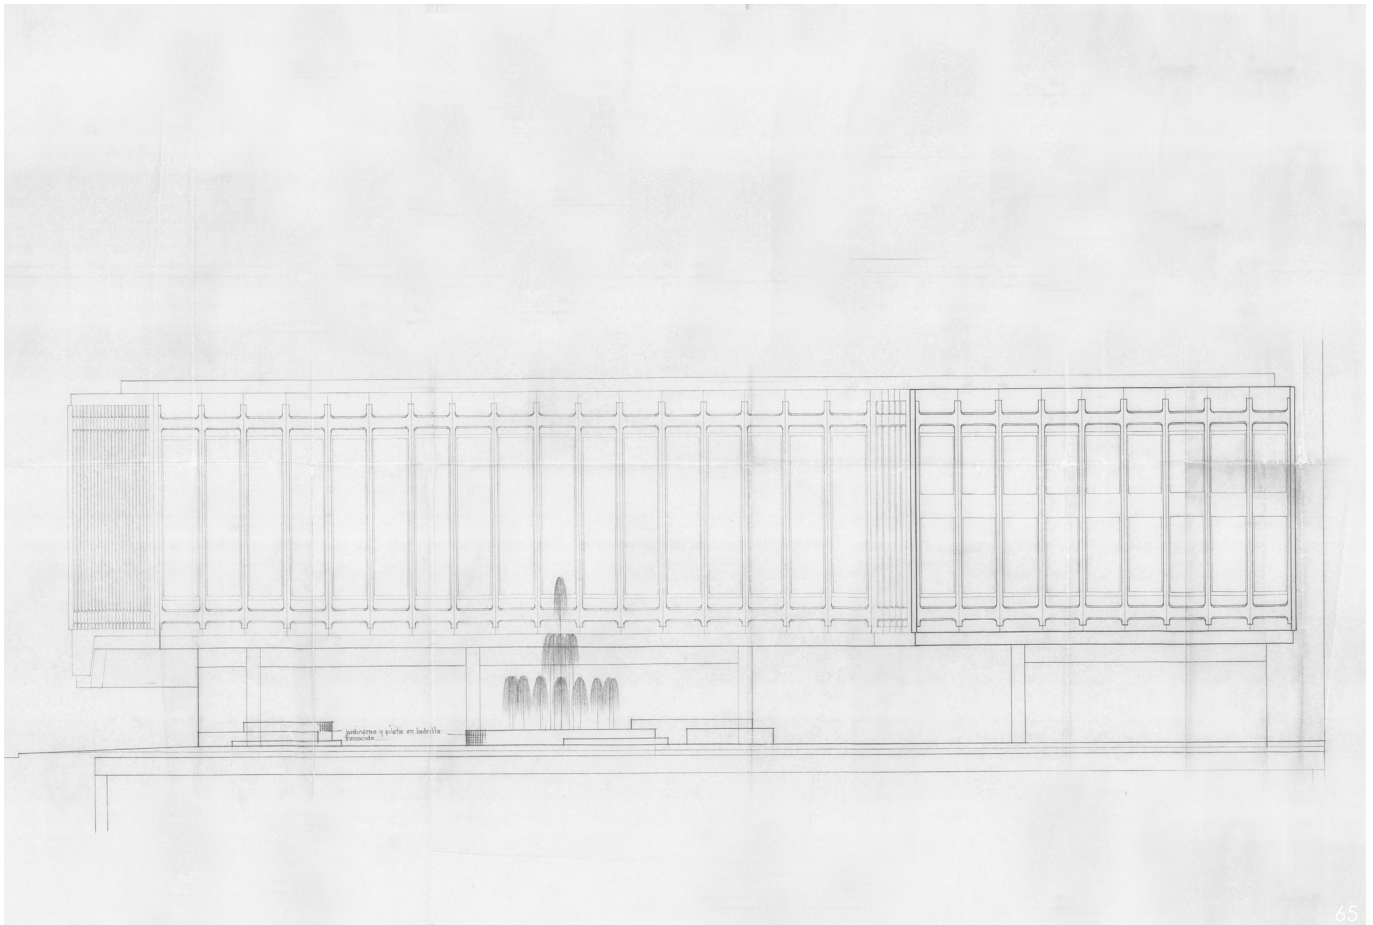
Plano original "Anteproyecto fuente", donde se visualiza parte de la plataforma desde la Carrera 7°
